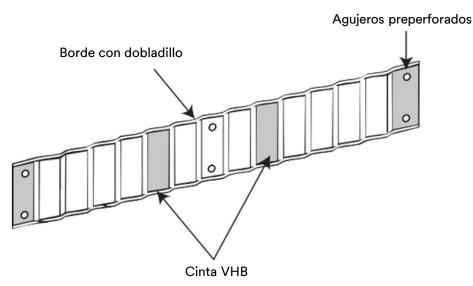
Partes de un panel LDS que se han preparado para su instalación.
